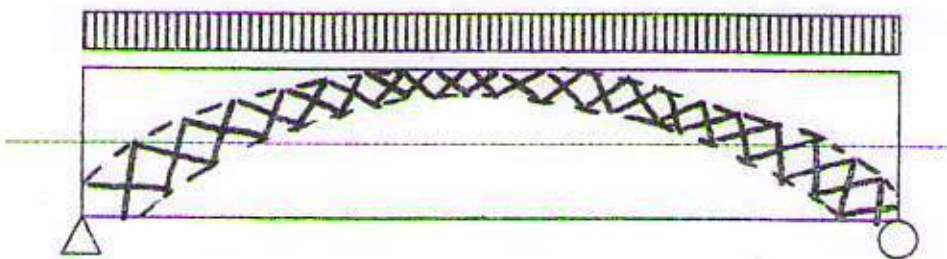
Comportement à la ruine d'une poutre sans étriers
